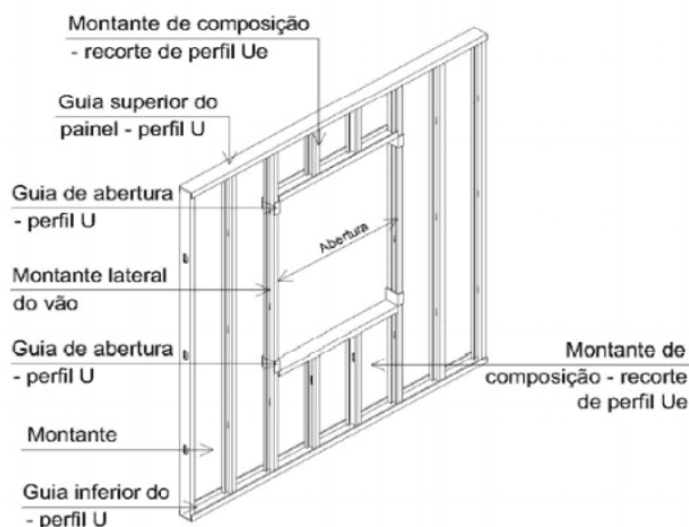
Desenho esquemático de painel não estrutural. Fonte: CRASTO,2006. p.47
